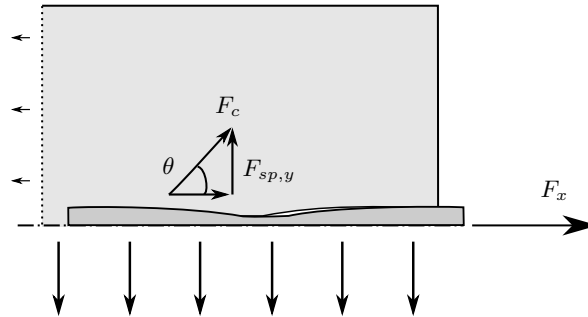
Neigung der resultierenden Betondruckstrebe zur Längsachse
